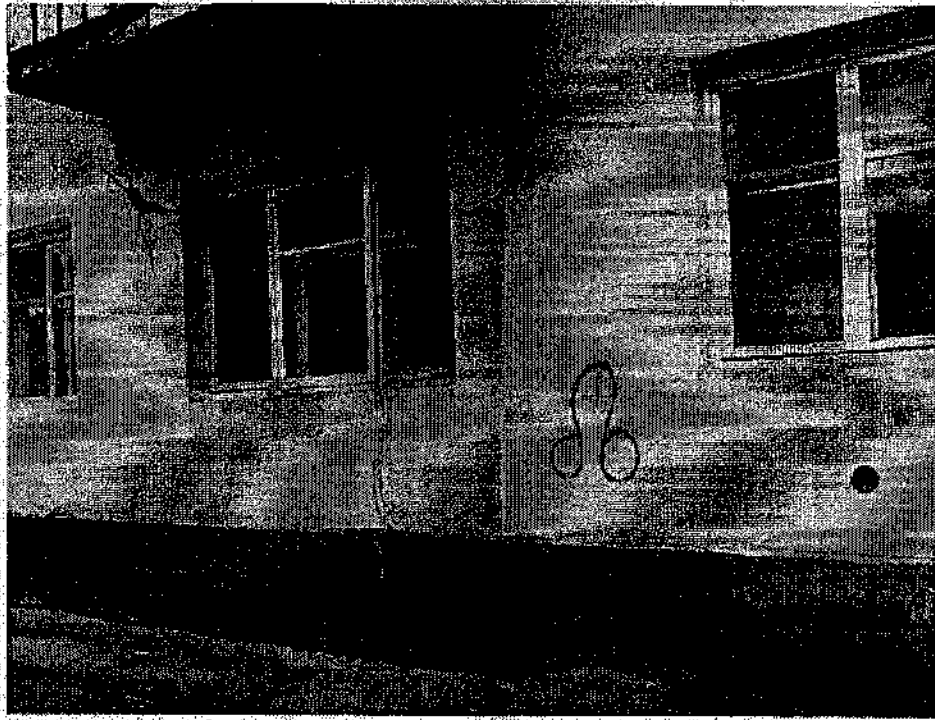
Трещина под окном 1-го этажа дворового фасада с раскрытием до 1 мм
